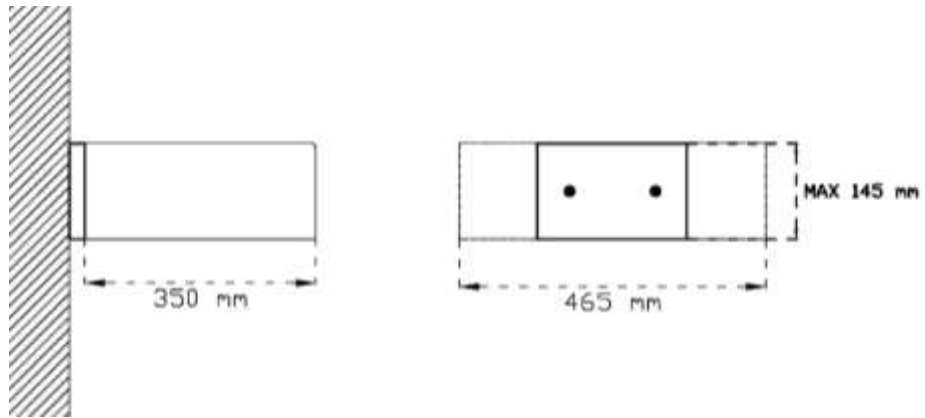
Apparecchi per fissaggio a parete per aree vincolate - Opzione 1 - Installazione tipica con staffa a muro tipo piastra per fissaggio diretto (senza codolo)
